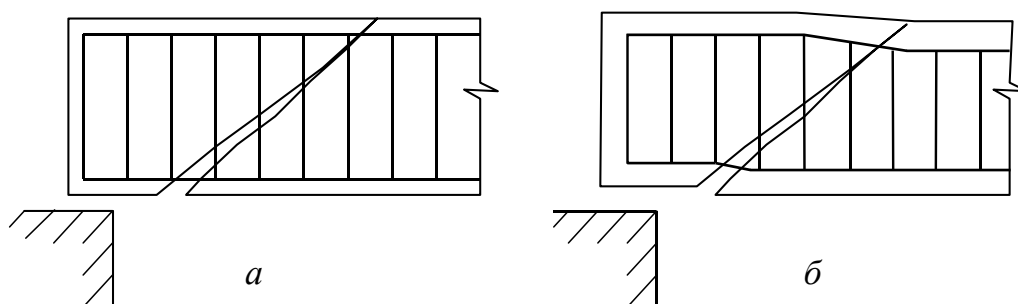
Картина разрушения по наклонным сечениям:
